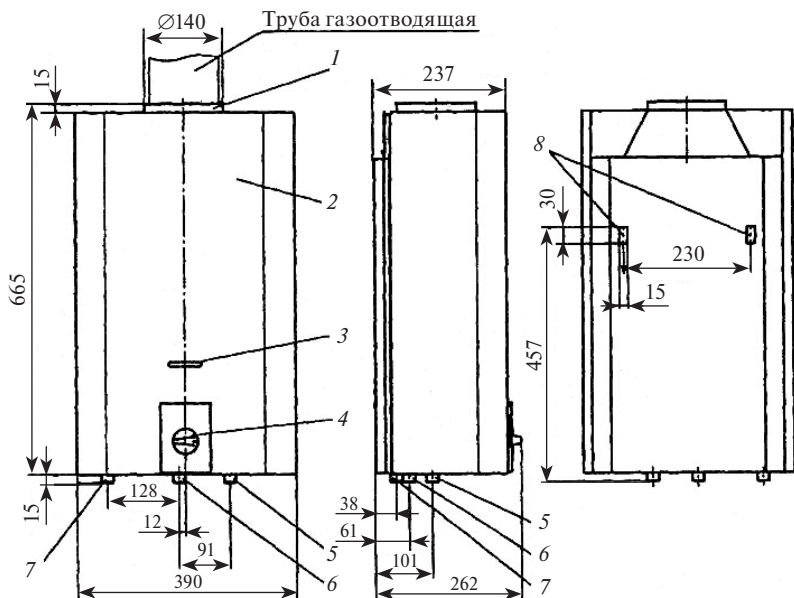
Внешний вид, габаритные и присоединительные размеры аппарата: 1 – патрубок; 2 – облицовка; 3 – окно смотровое; 4 – ручка; 5 – штуцер подвода холодной воды (резьба 1/2"); 6 – штуцер подвода газа (резьба 1/2"); 7 – штуцер отвода горячей воды (резьба 1/2"); 8 – монтажные отверстия
